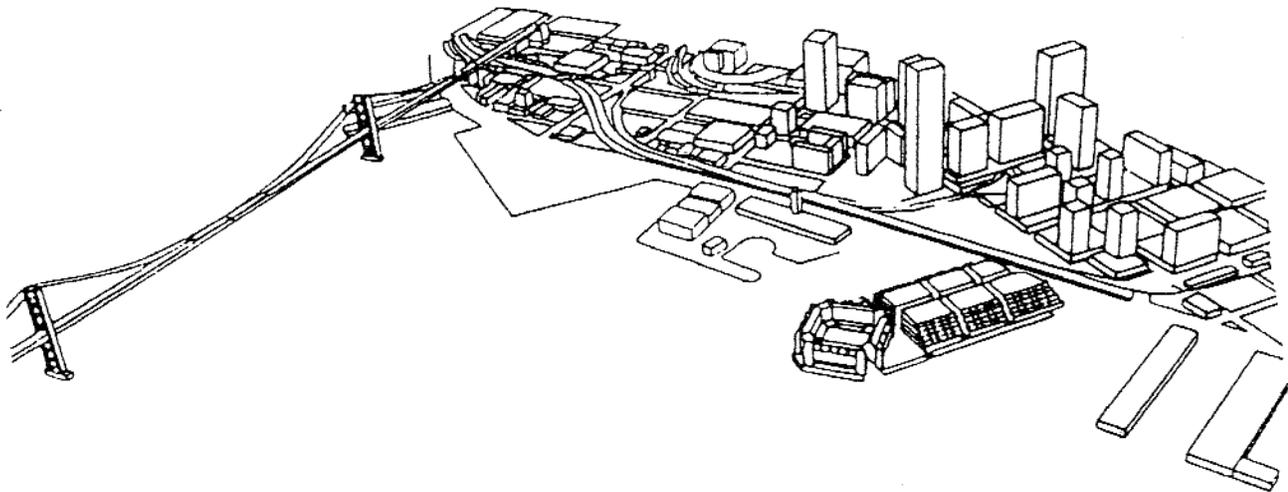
Imagen de espacio exterior (vista a vuelo de pájaro), proyección con planos de proyección inclinado
